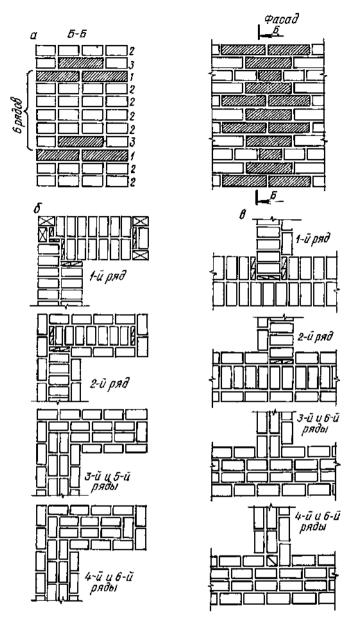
Шестирядная система перевязки швов: а – фасад; б – кладка стен с вертикальным ограничением и углов; в – кладка примыканий стен
